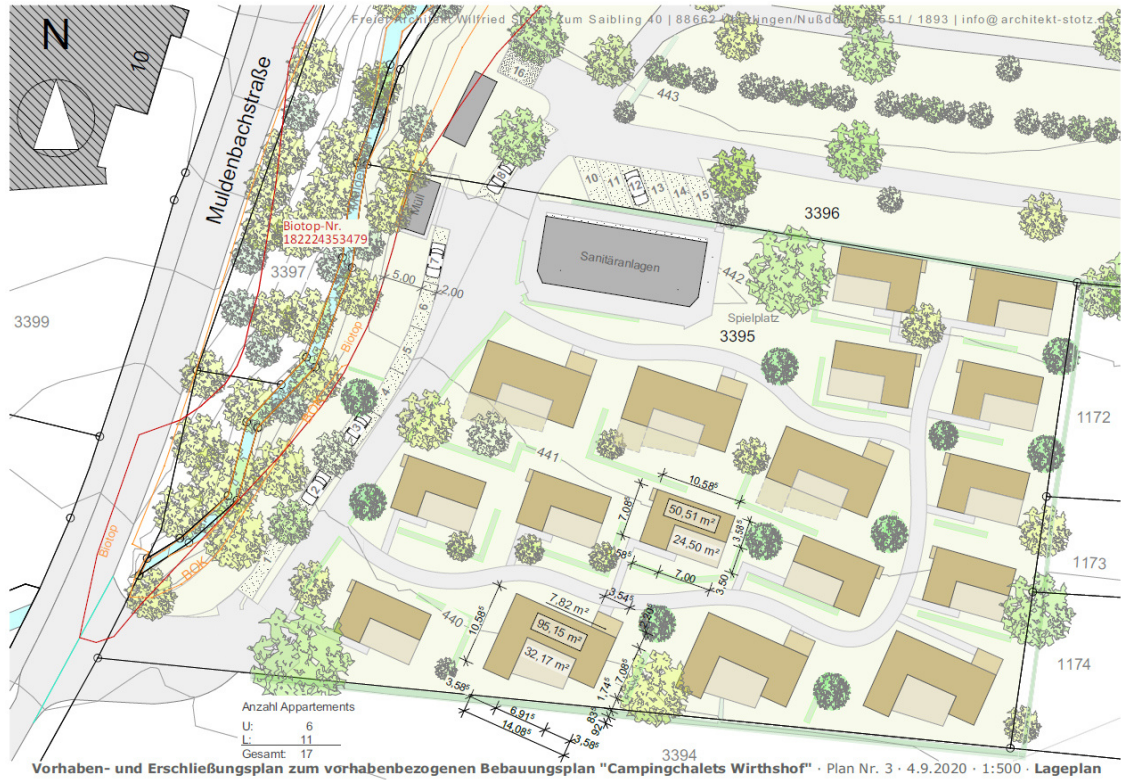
Lageplan Chalets, ohne Maßstab [2]
